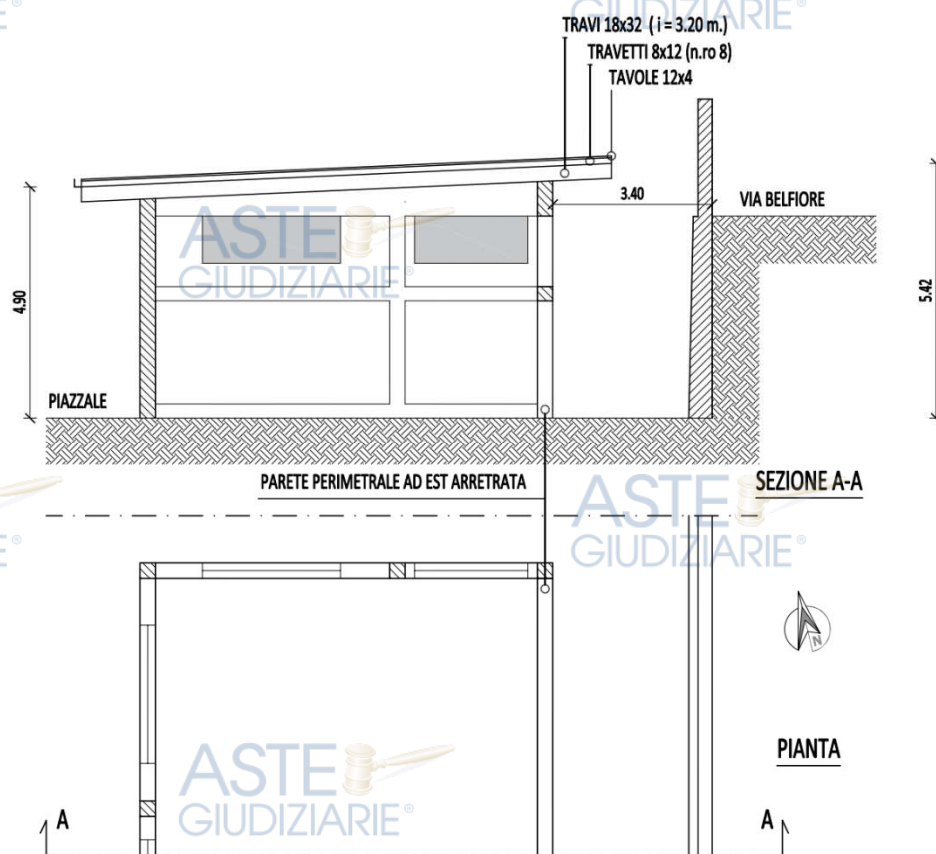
Stralcio pianta e sezione del capannone post demolizione
